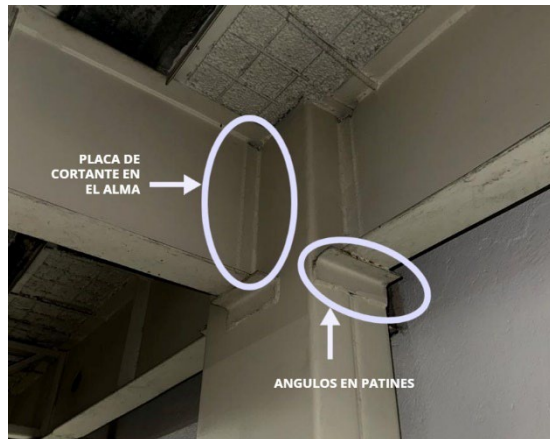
Viga I soldada patín y alma con ángulos.
